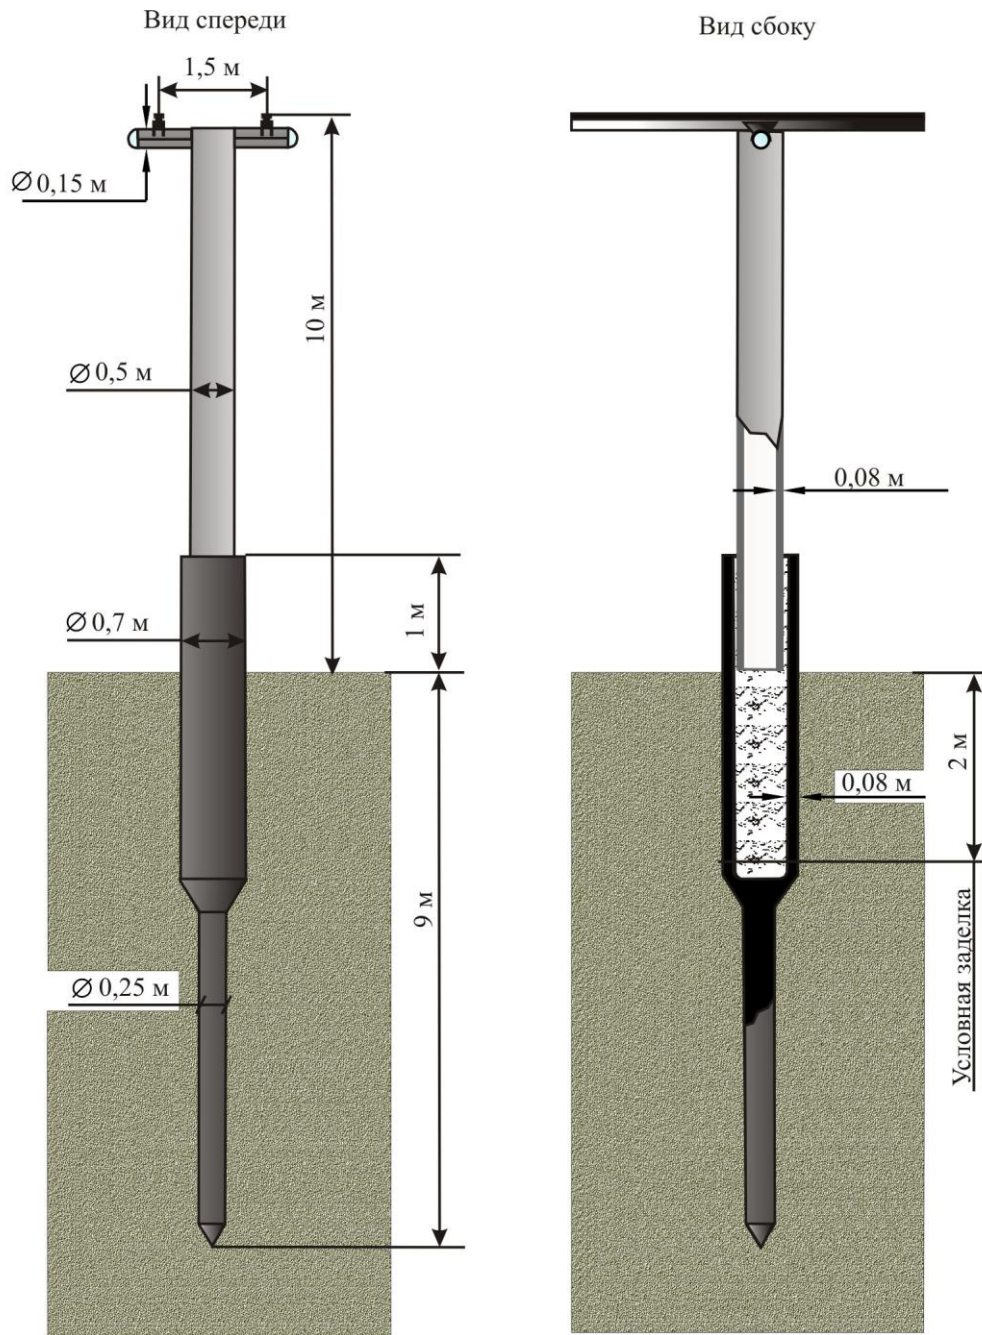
Габаритные размеры и схема заделки промежуточной поддерживающей опоры двухрельсового СТЮ (для одного пути)
